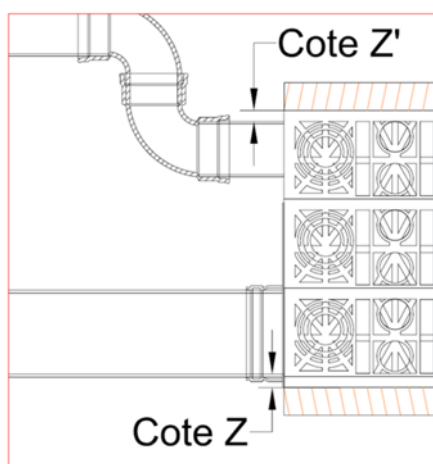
Caractéristiques dimensionnelles du clip d'assemblage
